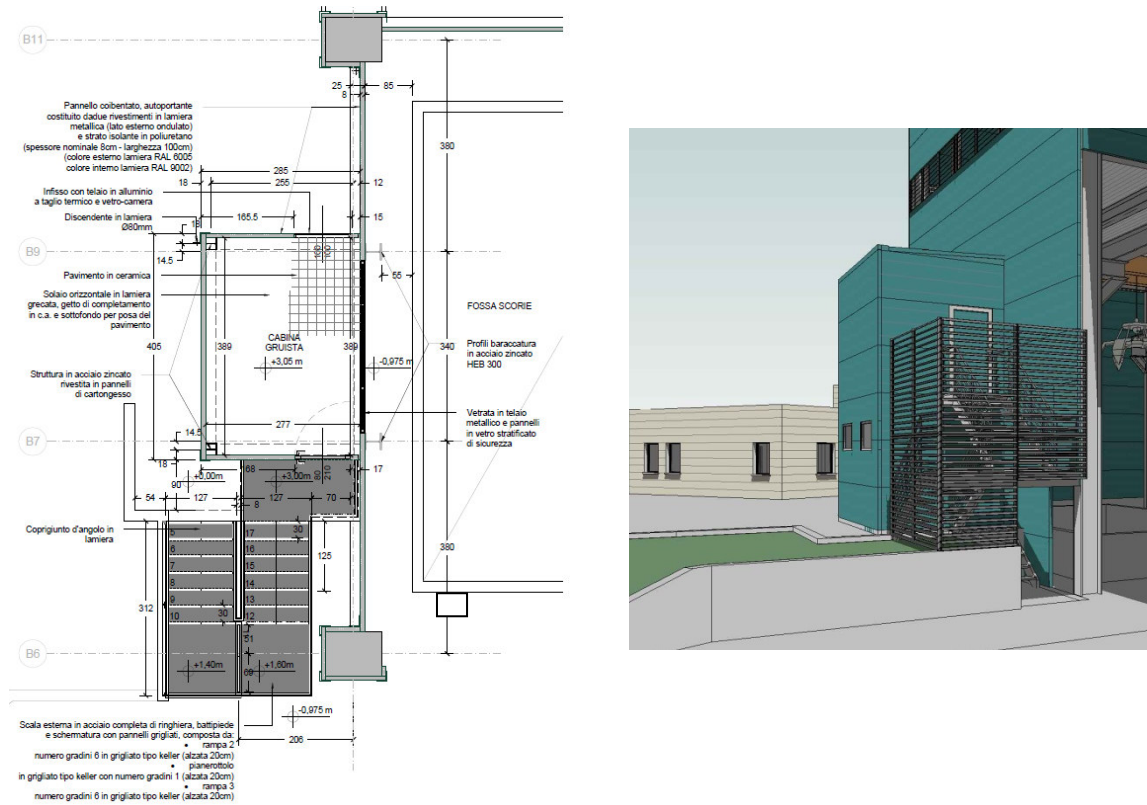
Edificio Fossa Scorie – dettaglio pianta e vista prospettica della cabina gruista
